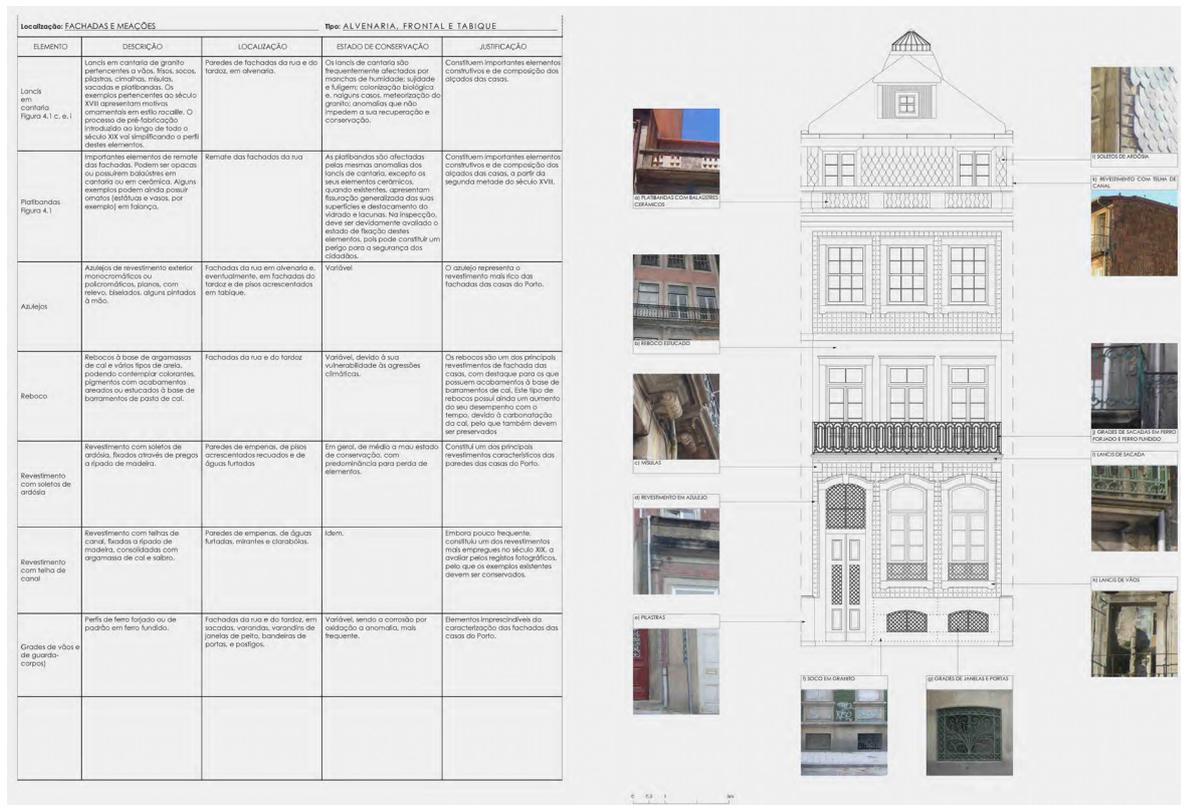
Levantamento e registo de elementos de valor em fachadas da rua.
